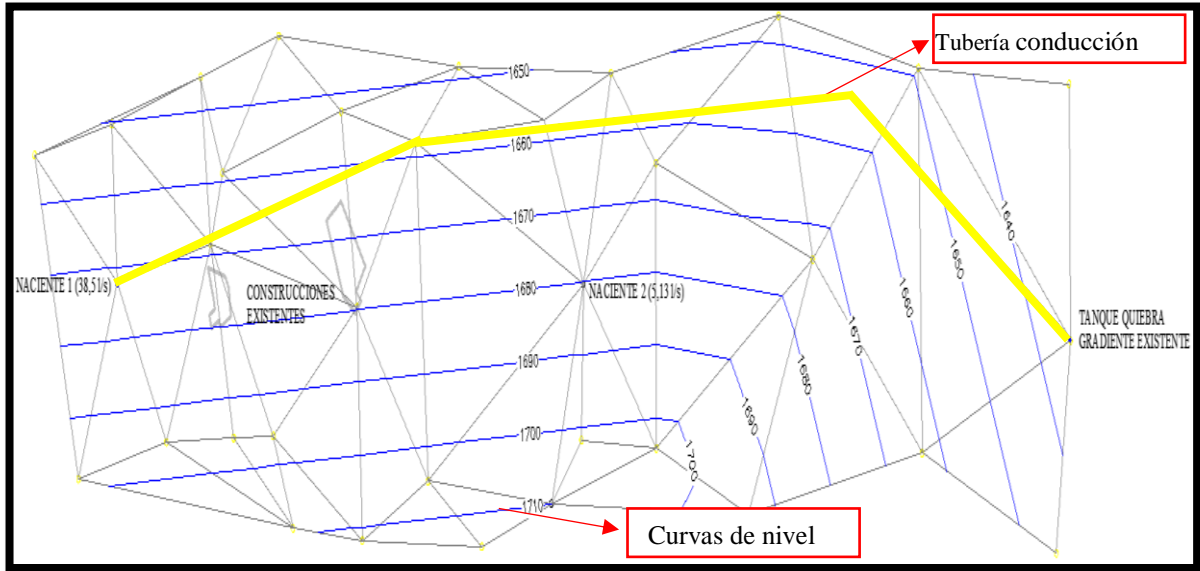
Planta del perfil 1 de la tubería de conducción, 2013.
